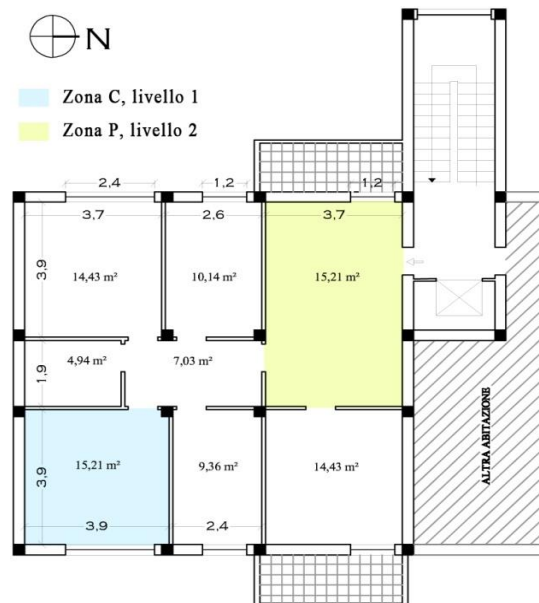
99 - Individuazione in pianta delle zone climatiche C e P
